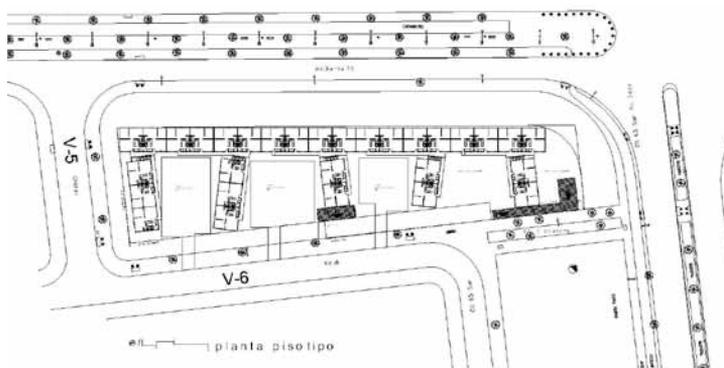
Planta piso tipo. El proyecto se cierra hacia la vía principal y se abre hacia el sur; las cinco barras puestas perpendicularmente bajo ángulos de alrededor de 80° conforman cuatro patios.
